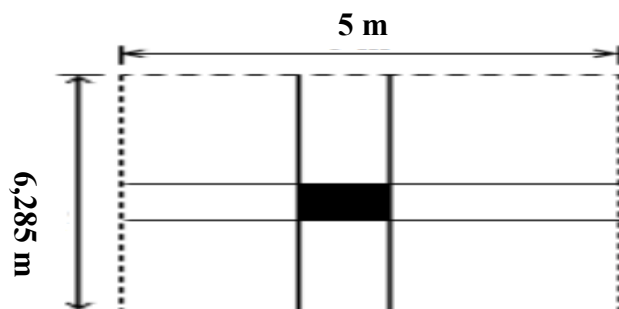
L'effort N revenant sur le poteau le plus sollicité
